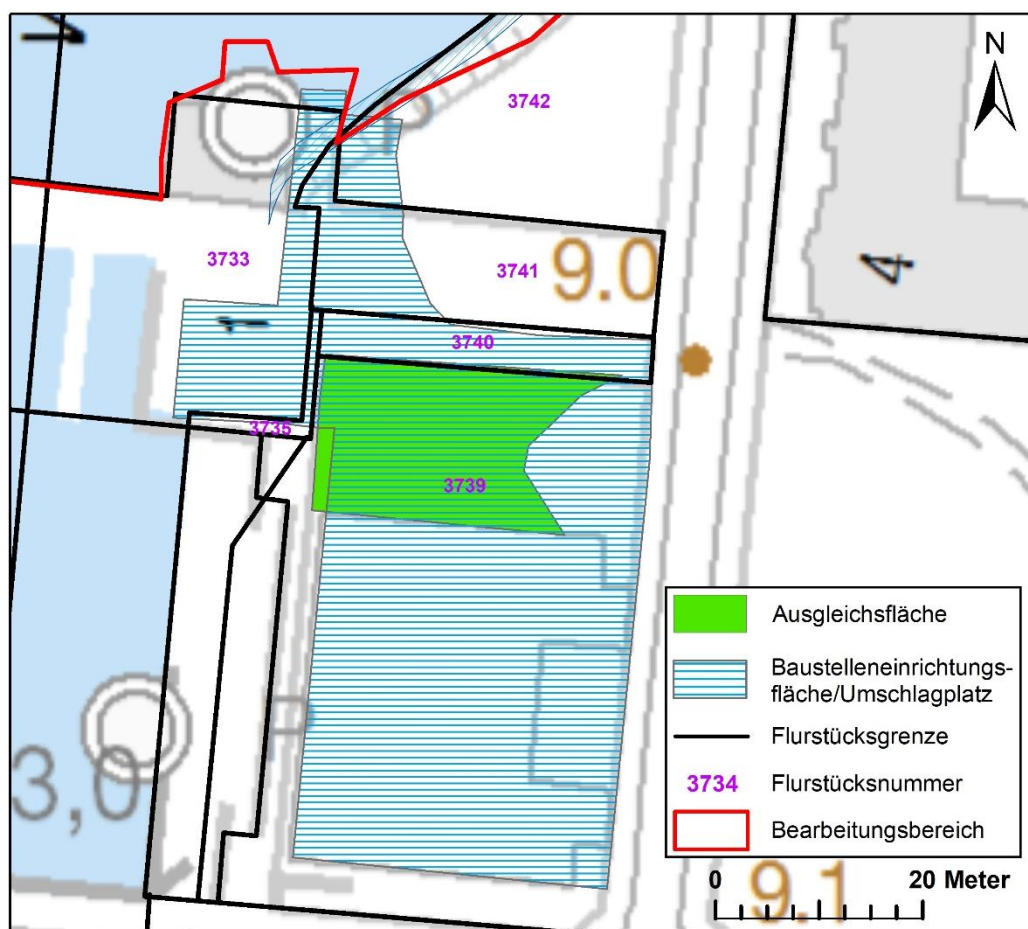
Vorgesehene Lage der Baustelleneinrichtungsfläche, Lage der betroffenen Ausgleichsfläche
